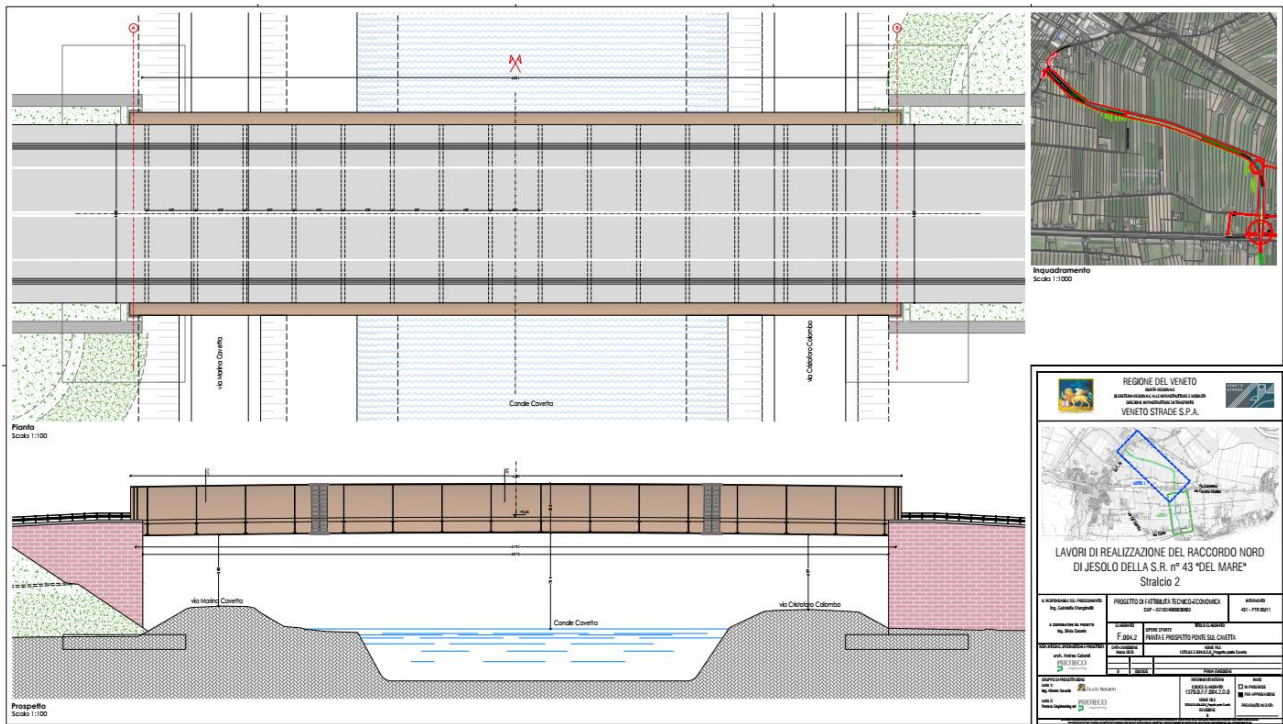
tavola di progetto "1370.0.F.F.004.2.D.0_Pianta-prospetto_Ponte Cavetta".
